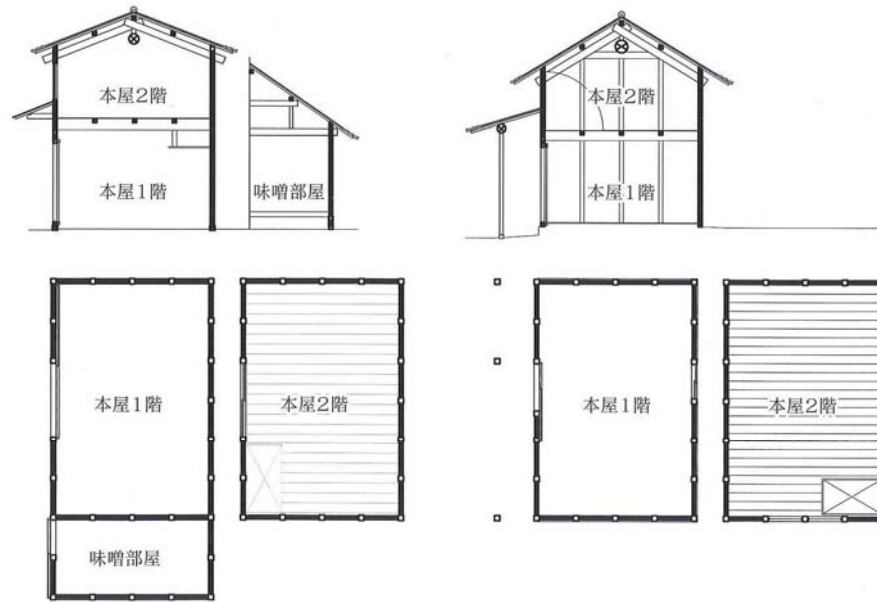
水塚の断面図・平面図（出典：『水塚パンフレット』）
